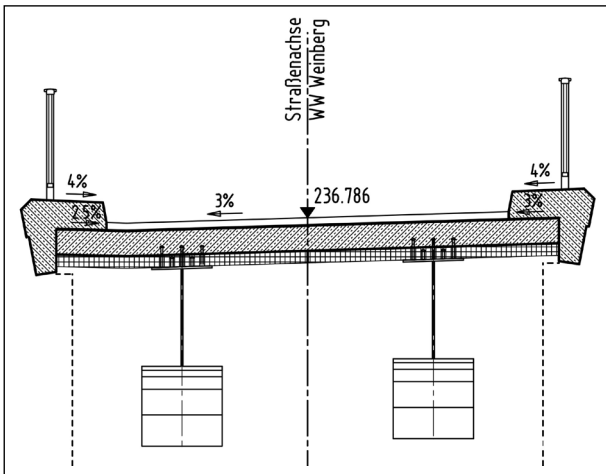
Regelquerschnitt, Zeichnung (DEGES)
